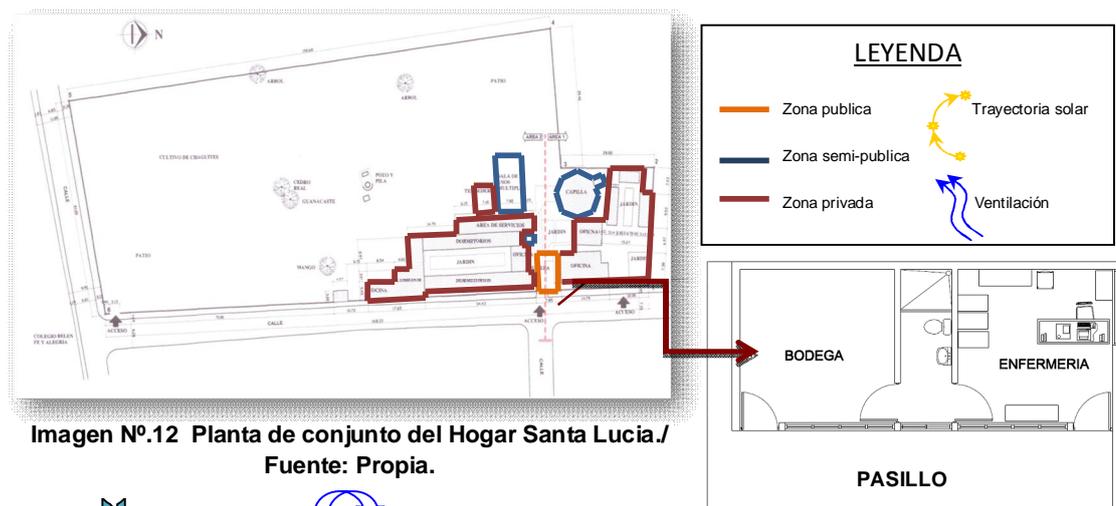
Planta de conjunto del Hogar Santa Lucia./
